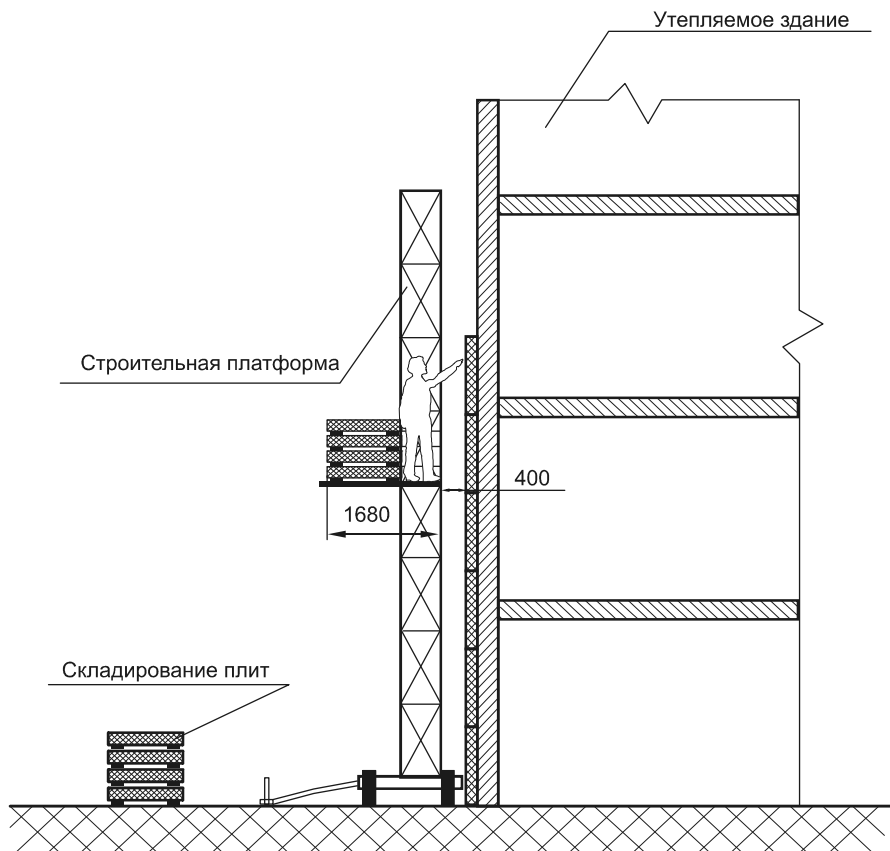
Технологическая схема устройства утепления наружных стен
